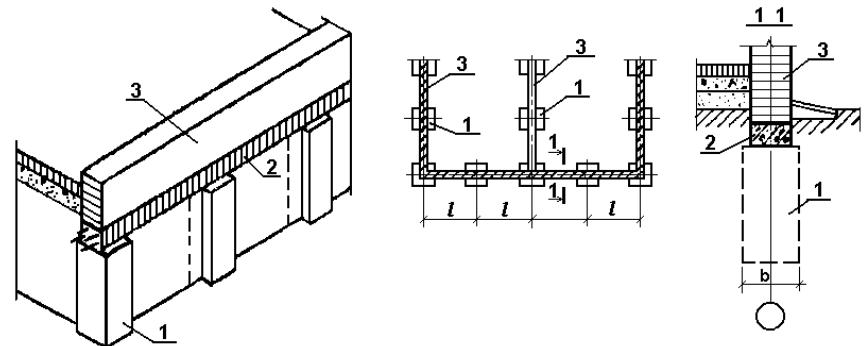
Столбчатые фундаменты под несущие и самонесущие стены (общий вид, план, разрез).
